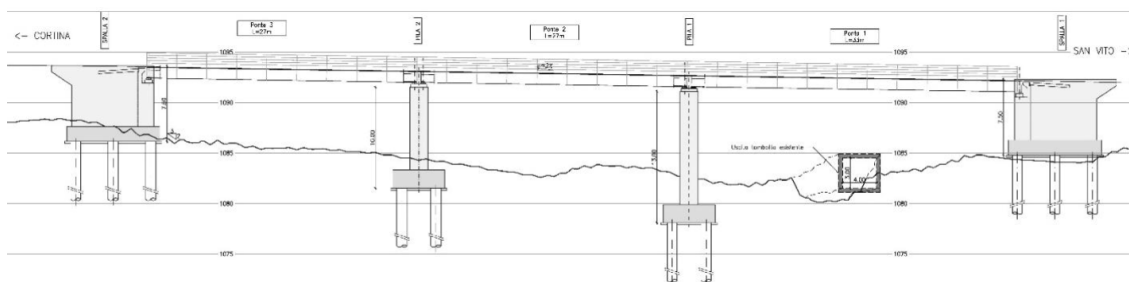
PROSPETTO PONTE PROVVISORIO
